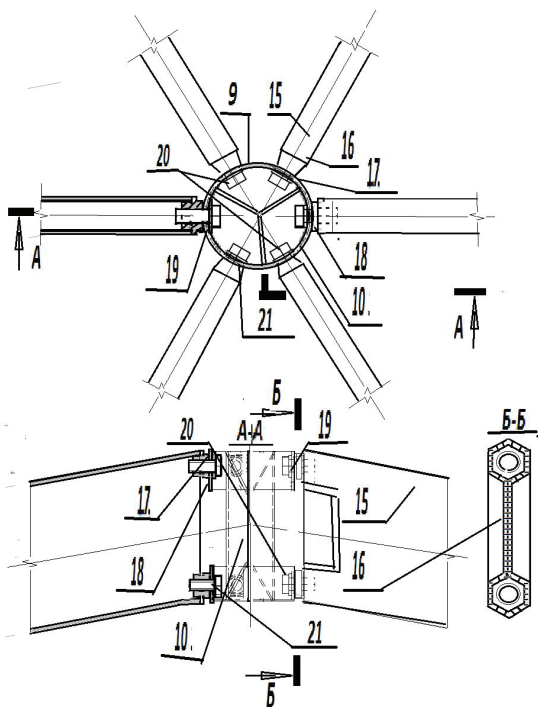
Узел соединения однослойной или однопоясной сборной сферической оболочки диаметром 24 м (12 м между опорами) из 6 секторов с углами на вершине 60° с разрезкой из шестиугольных панелей с треугольными вставками между ними: 15 – прямоугольные трубы-стержни; 16 – сплюснутые торцы труб; 17 – соединения на сварке торцевых парных фланцев; 18 – фланцы; 19 – резьбовые отверстия; 20 – болты; 21 – отверстия узловых элементов (пояснения по остальным п. п. на рис. 1–2, так как нумерация на рисунках сквозная)
